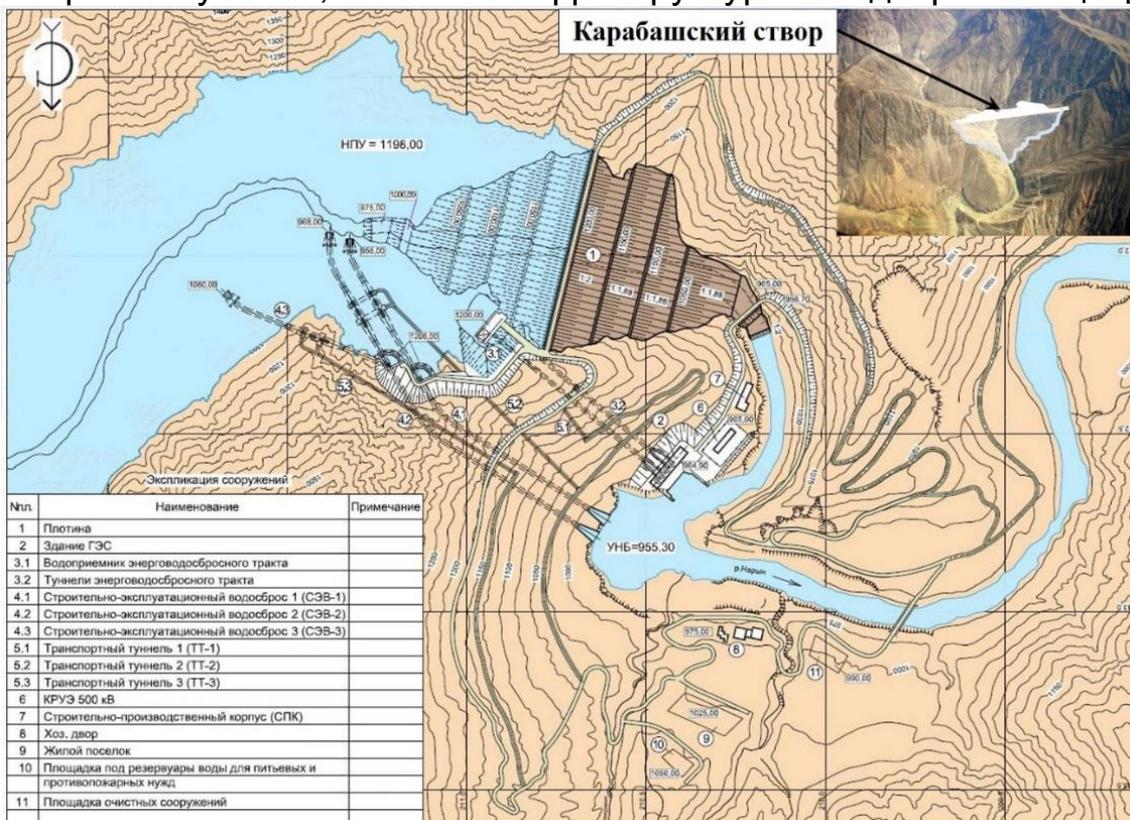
Генеральный план КГЭС-1: на врезке показан Карабашский створ плотины [1]
